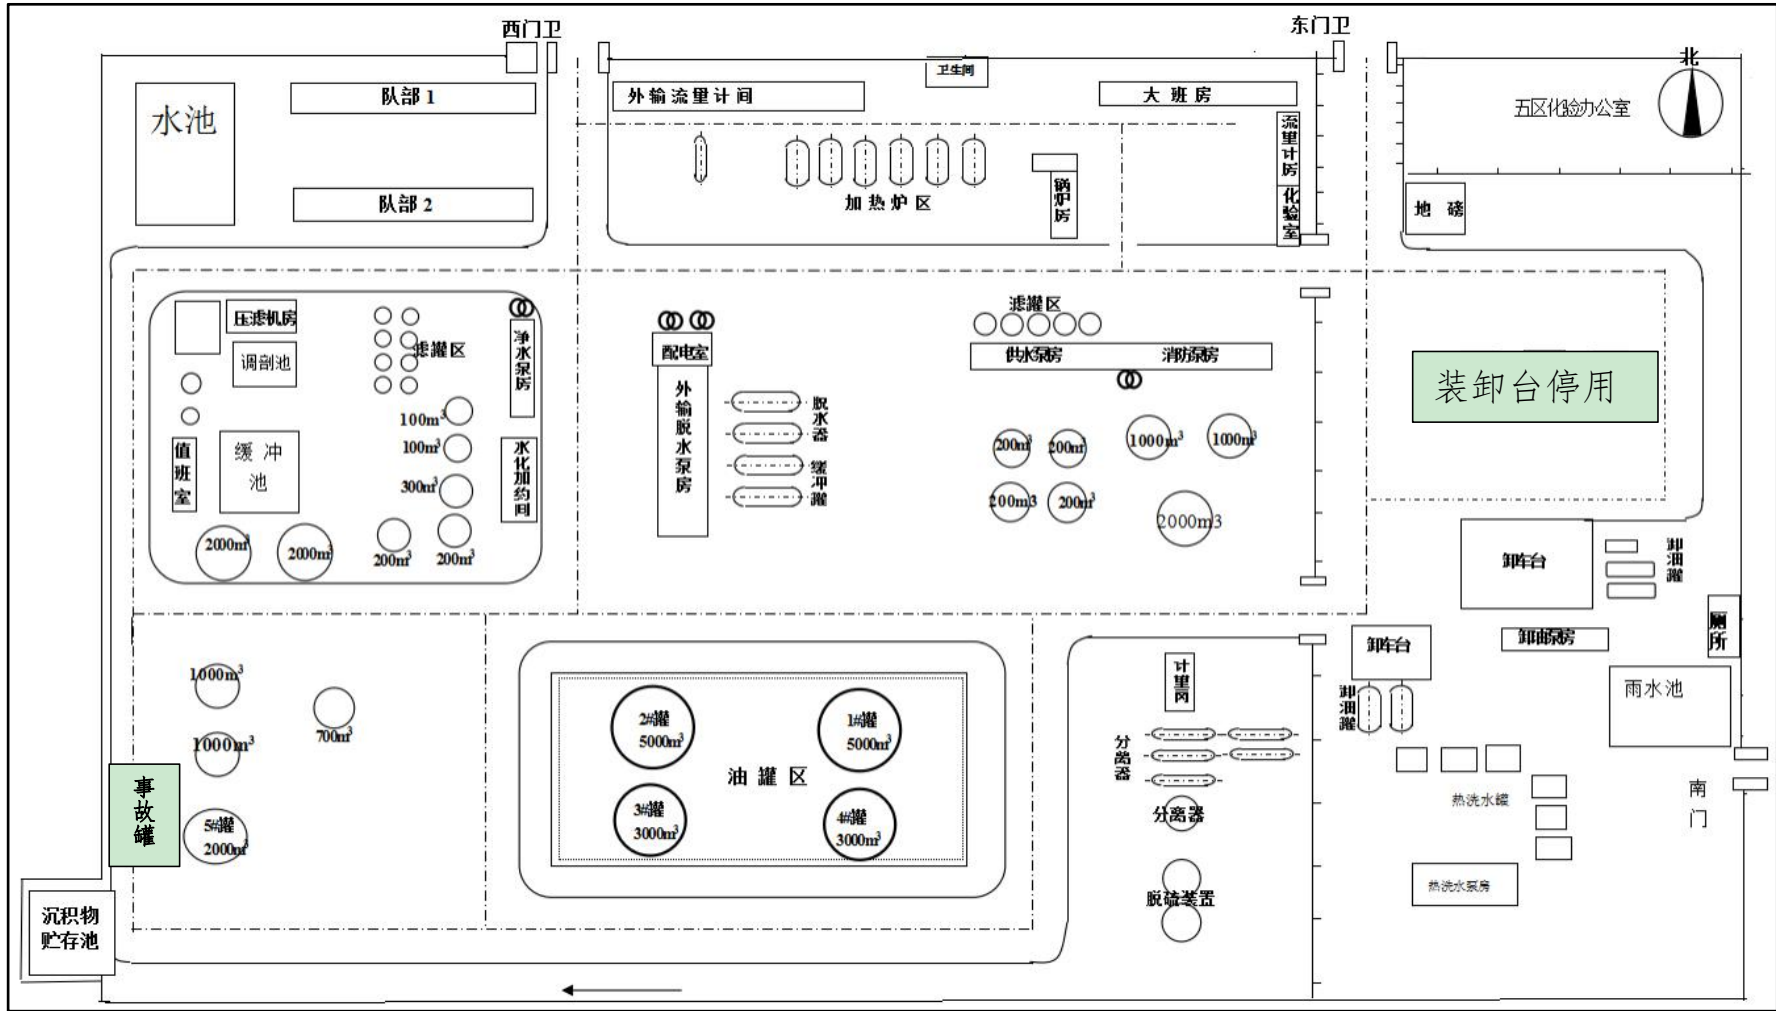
商河联合站及商河联沉积物贮存池平面布置示意图
